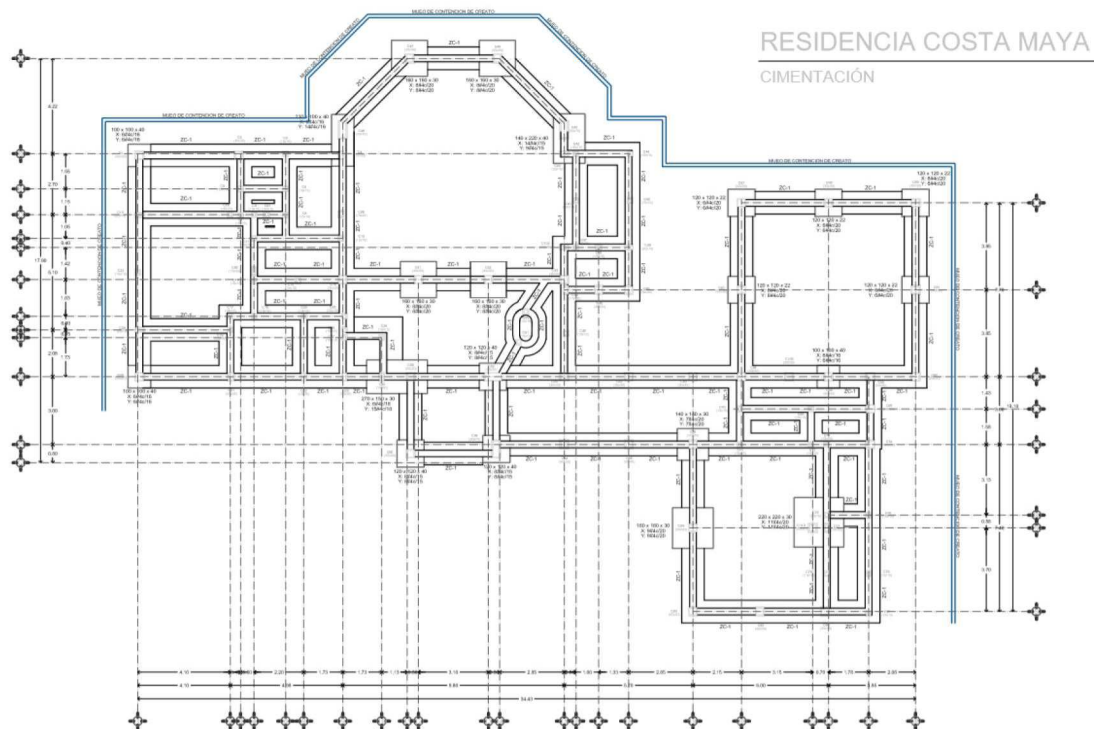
Planta estructural de la tipología de cimentación en zapatas aisladas.
